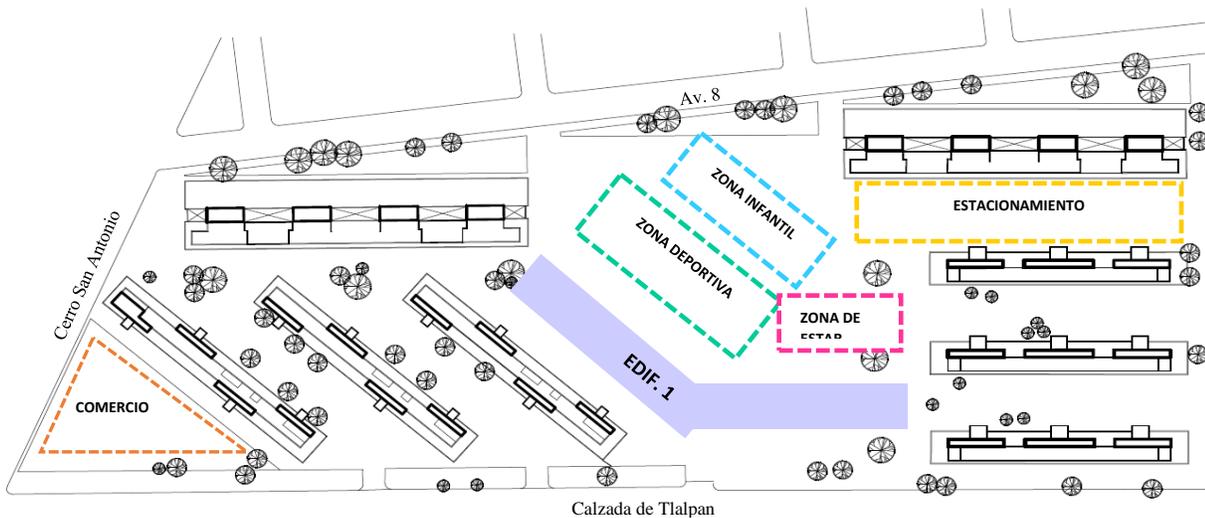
propuestas de intervención, emplazamiento y distribución de áreas.
